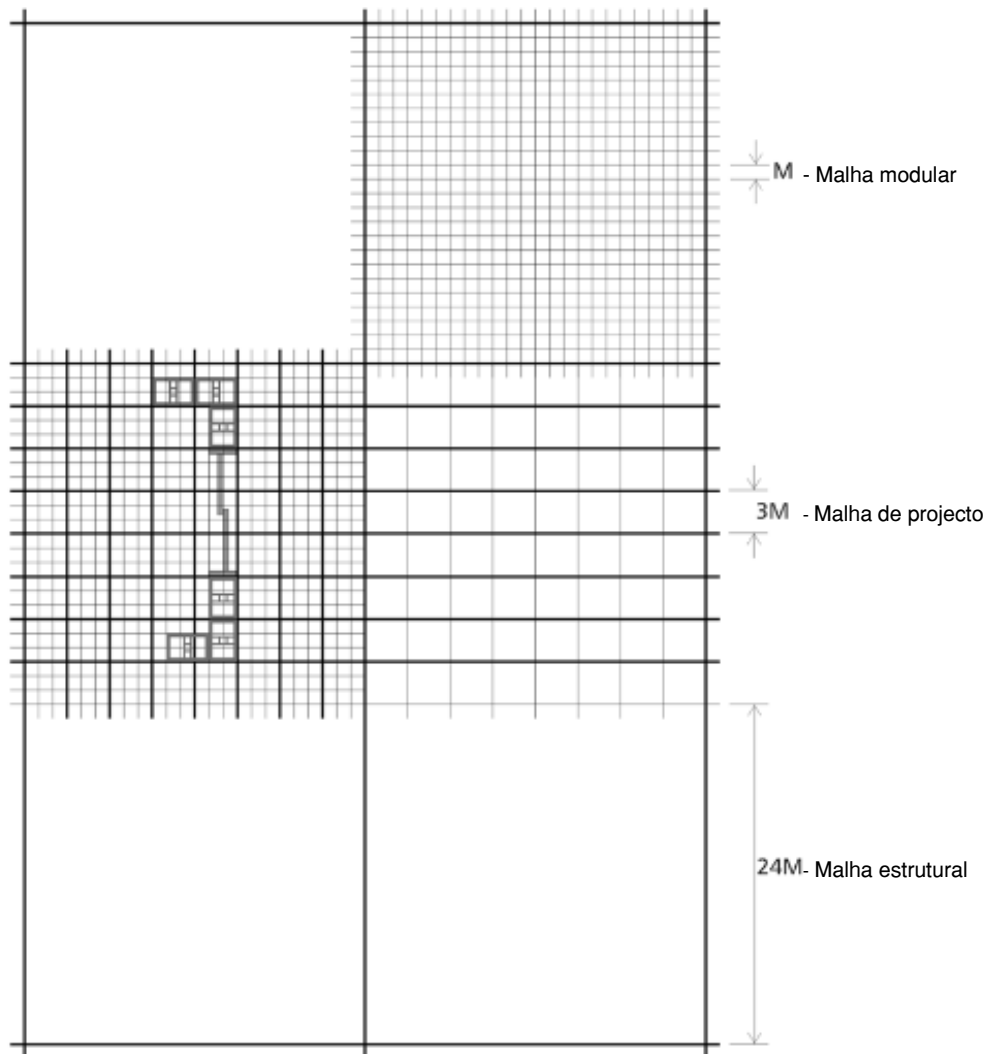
Tipos de malhas utilizadas no desenho arquitectónico (M- módulo).
